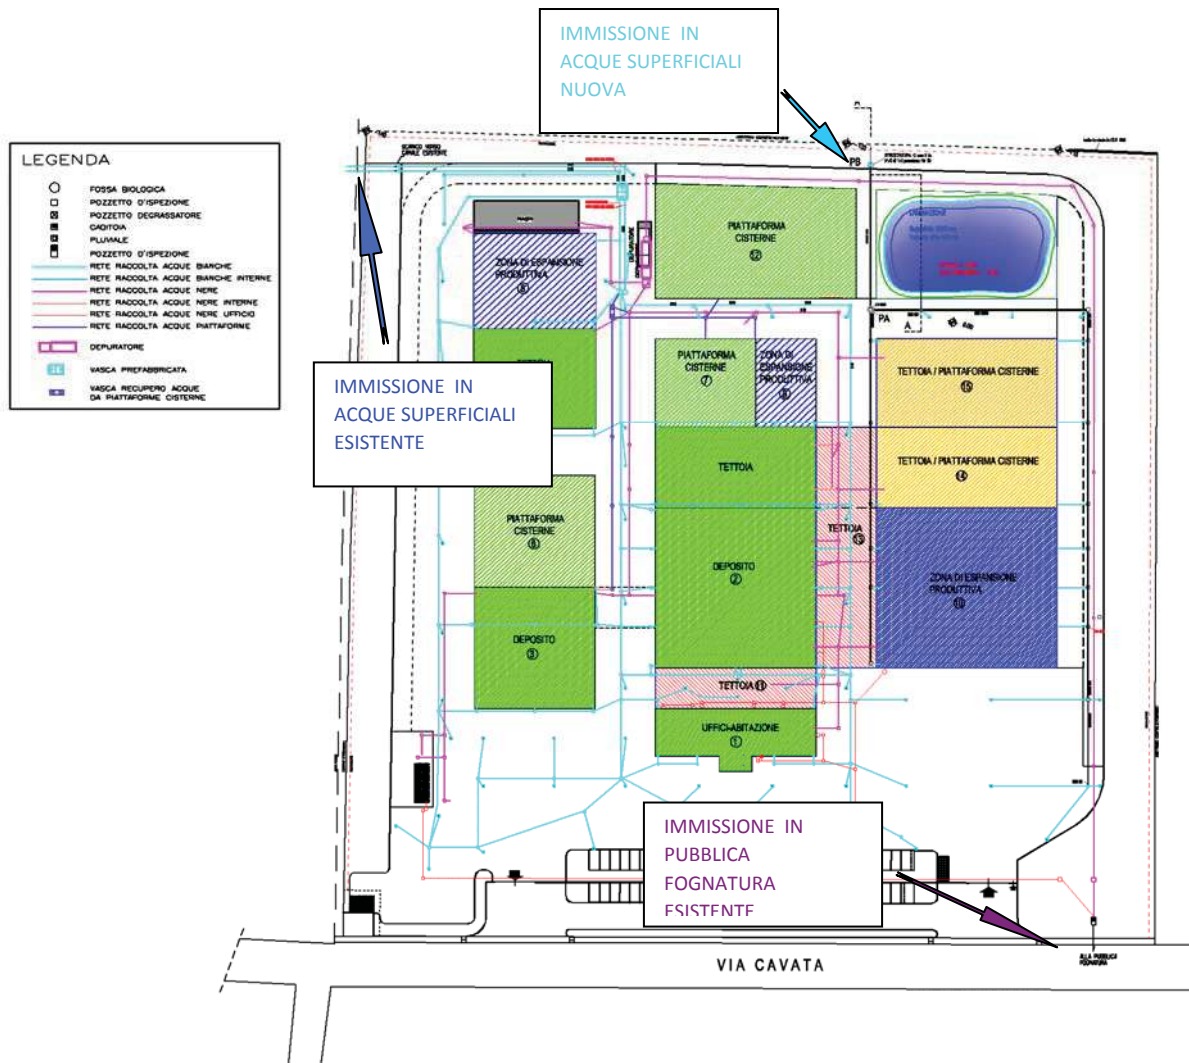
PLANIMETRIA GENERALE RETI FOGNARIE ESISTENTI E DI PROGETTO
